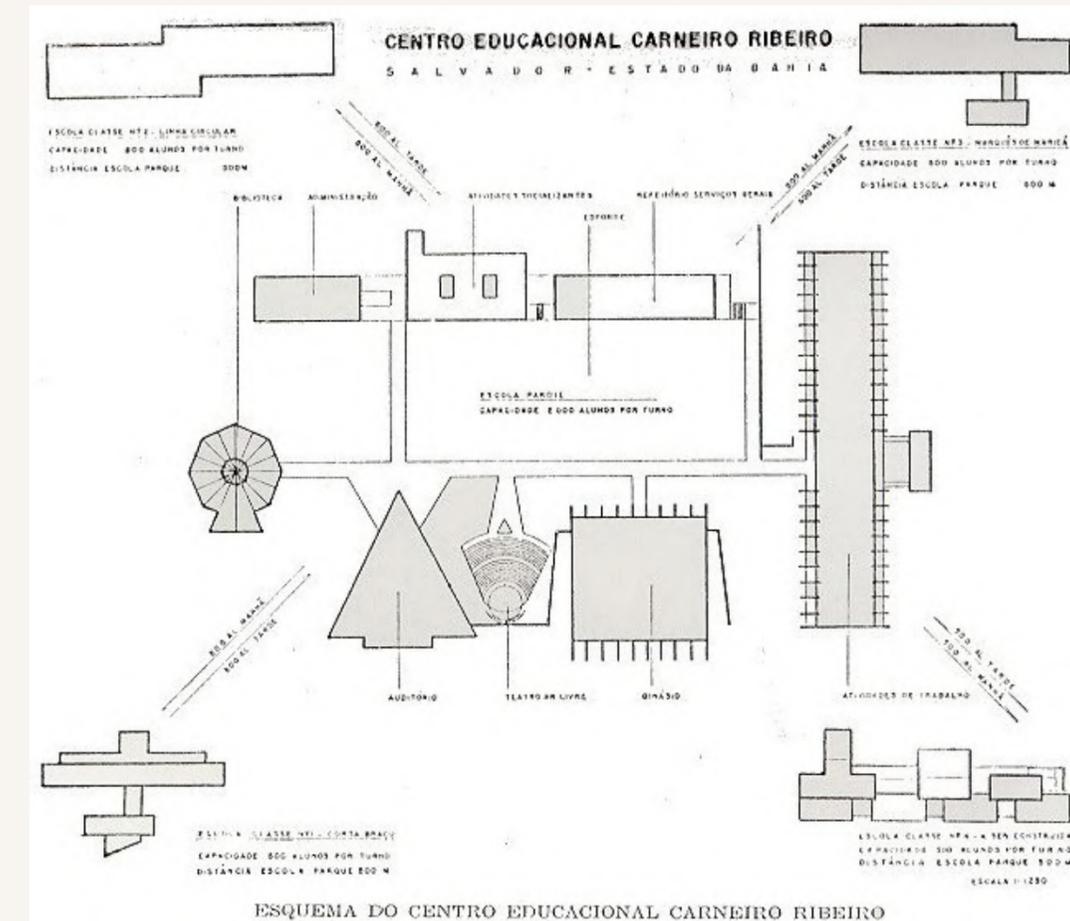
Planta esquemática do Centro Educacional Carneiro Ribeiro
